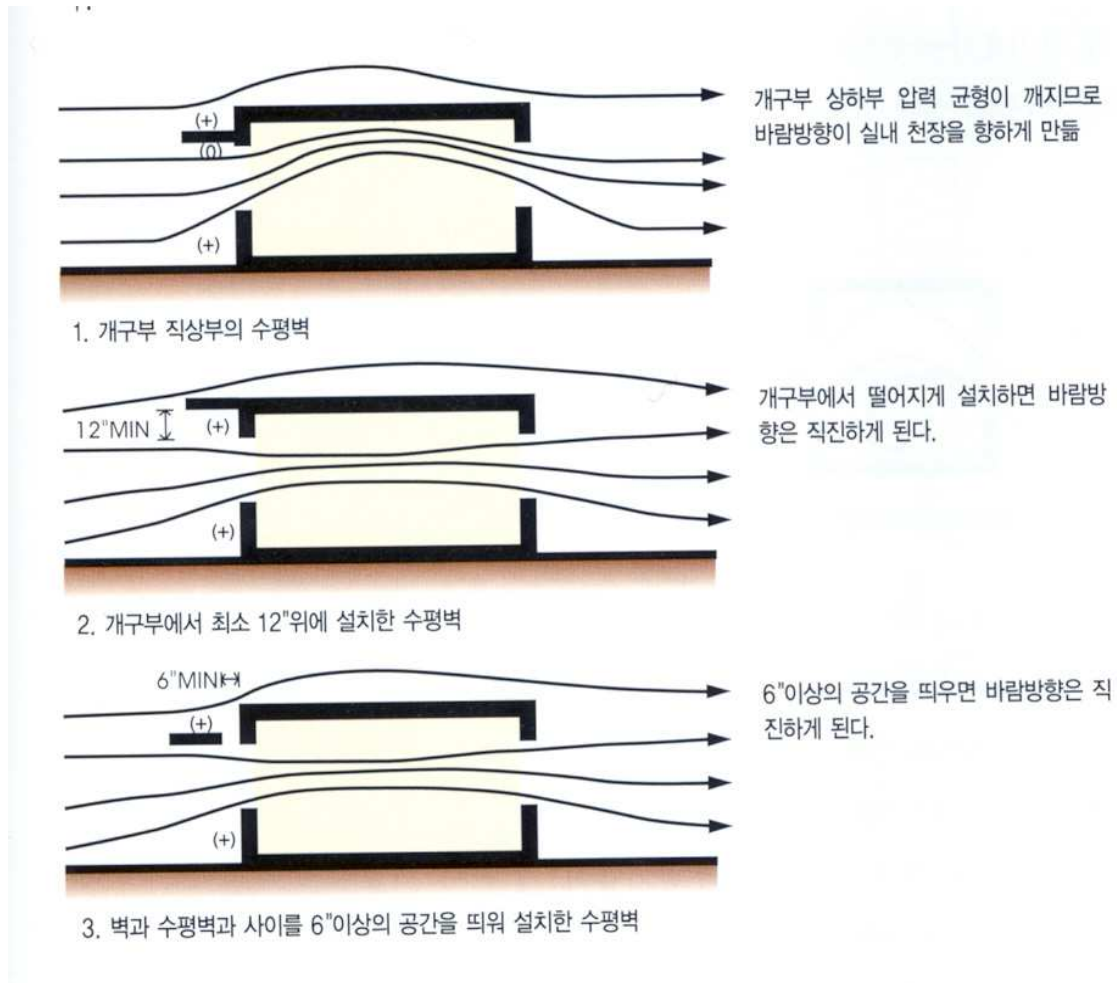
실내 환기효과를 증진시키기 위한 수평벽(horizontal overhang)의 개념도
